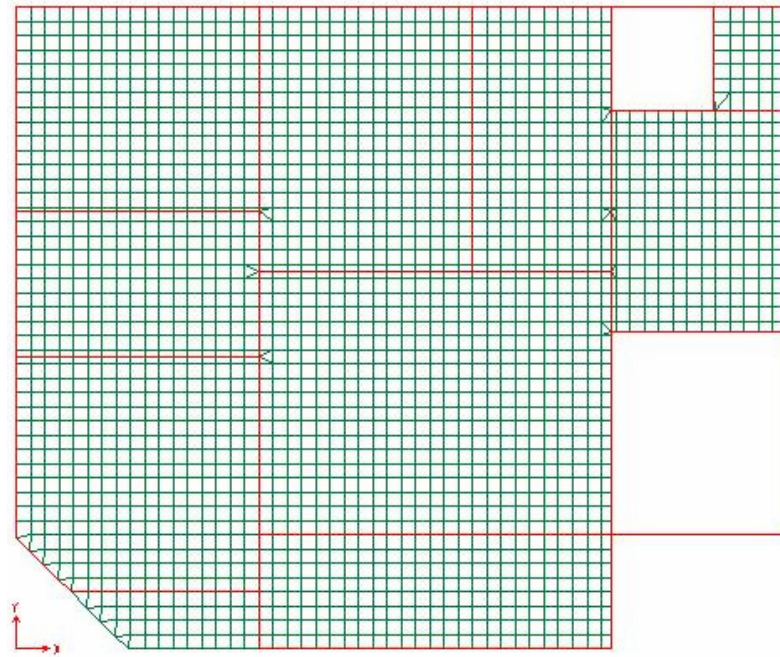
pavimento modelado em elementos finitos com malha de 25x25.
